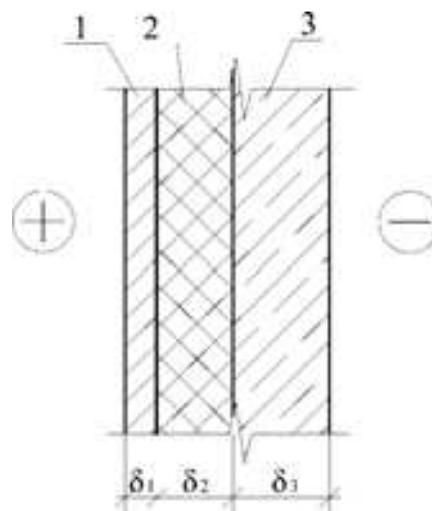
Конструкция кирпичной кладки, утепленной изнутри монолитным пенобетоном:
